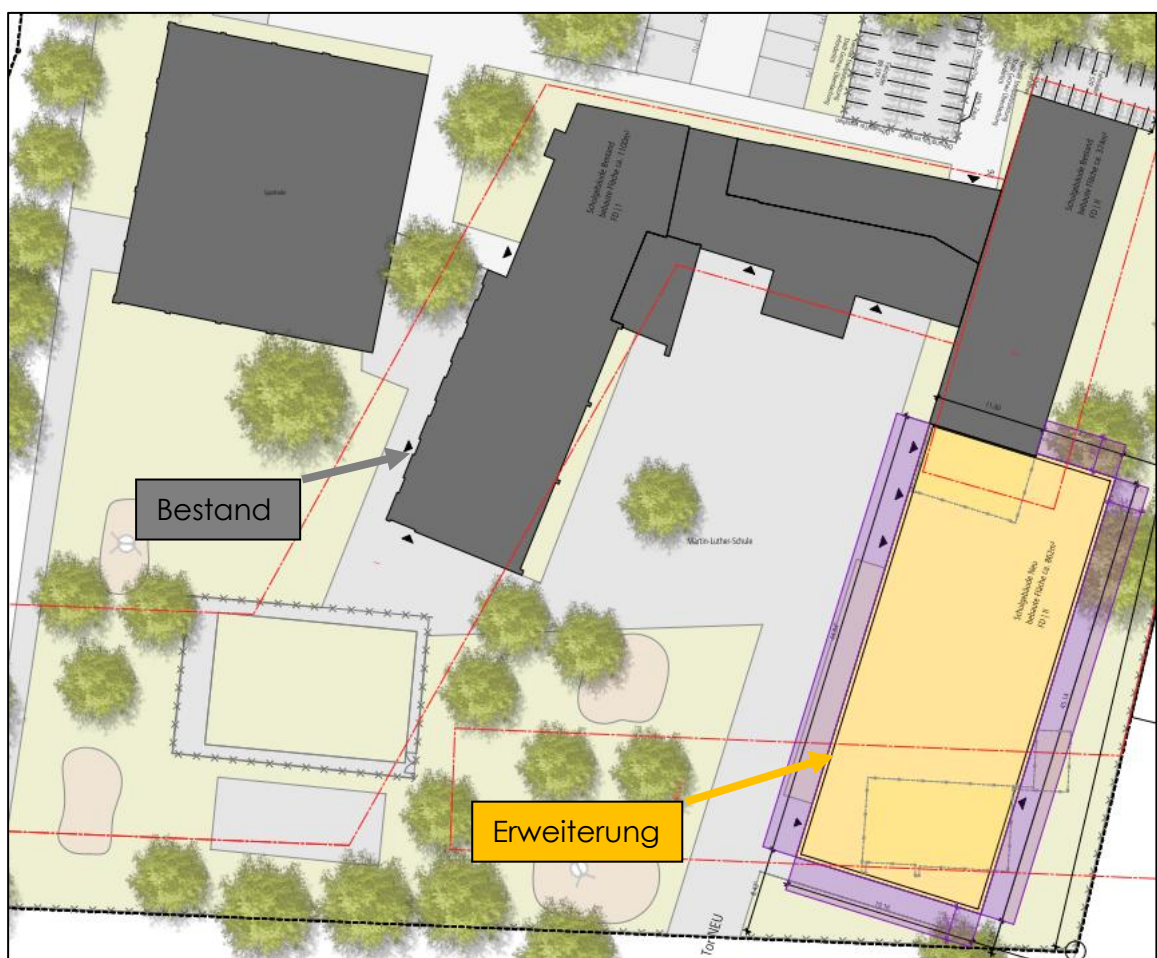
Lageplan mit Darstellung der Gebäudekomplexe
